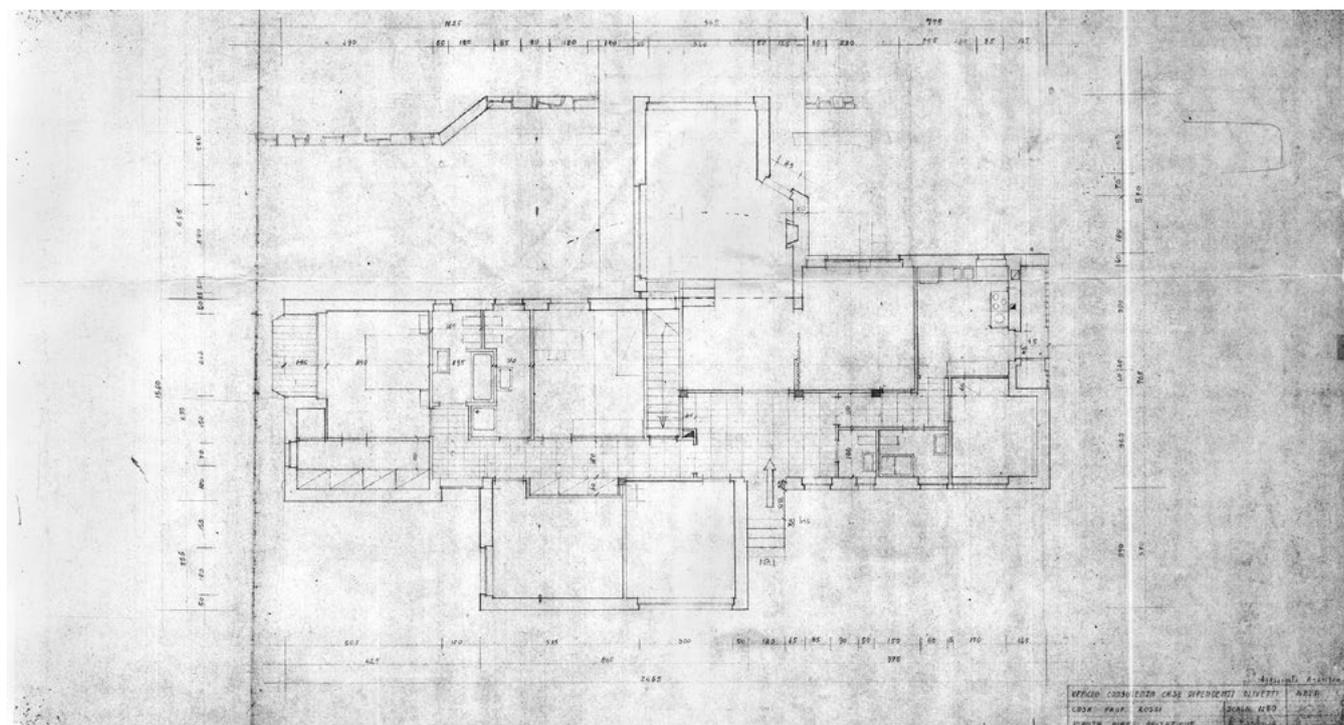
Pianta definitiva di villa Rossi (Archivio Edilizio Comune di Banchette).
